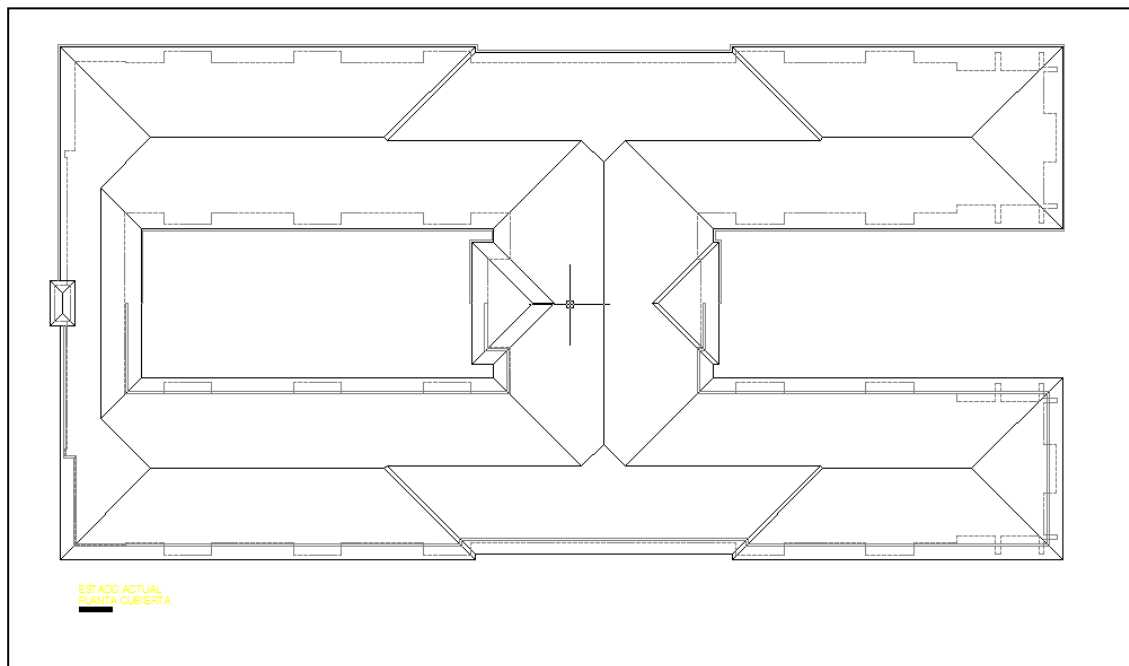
Detalle planta cuartel Almirante F. Moreno.
